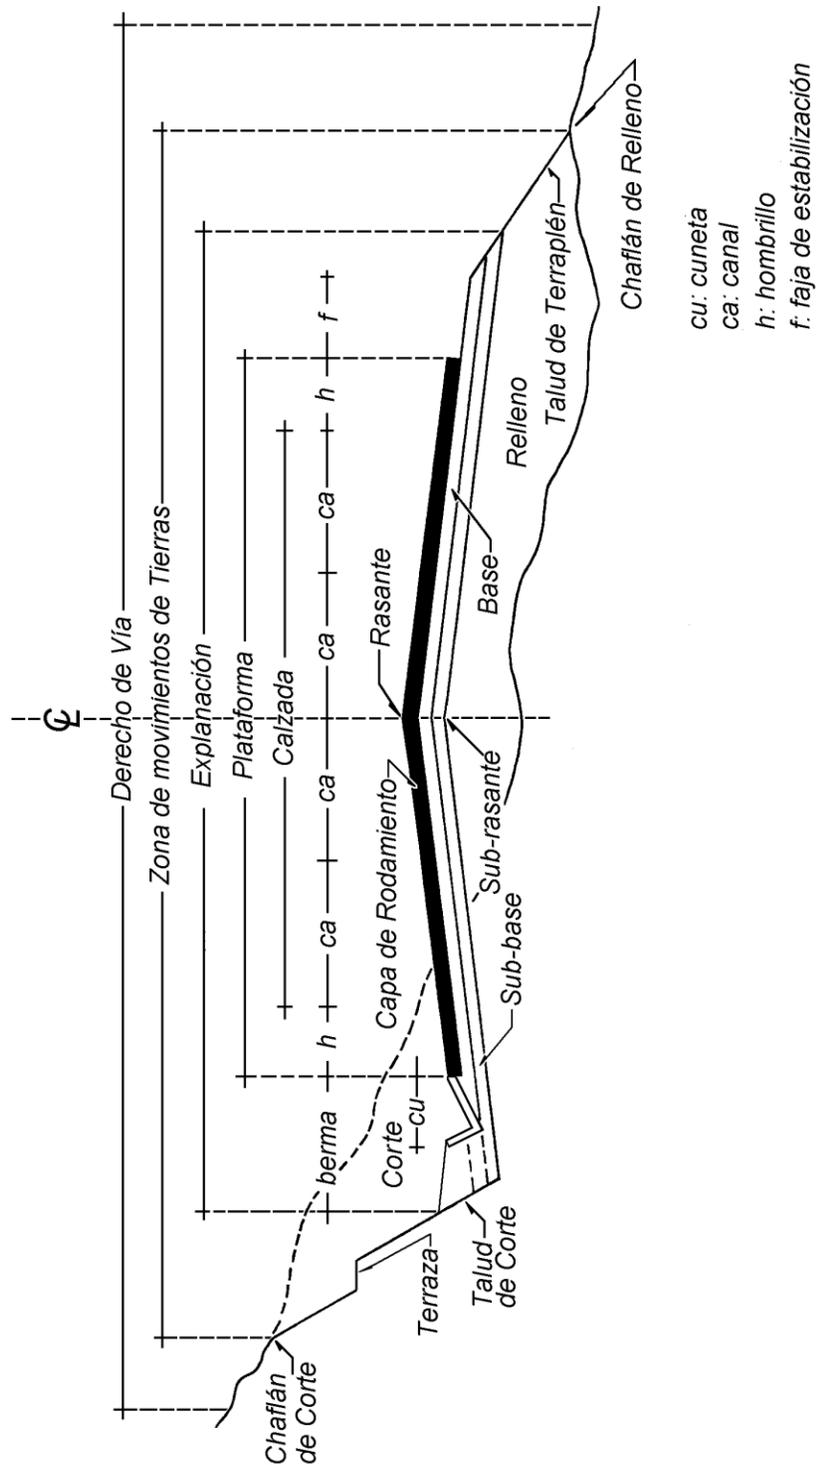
Sección Transversal Ideal de una Vía Multicanal de Calzada no Dividida
